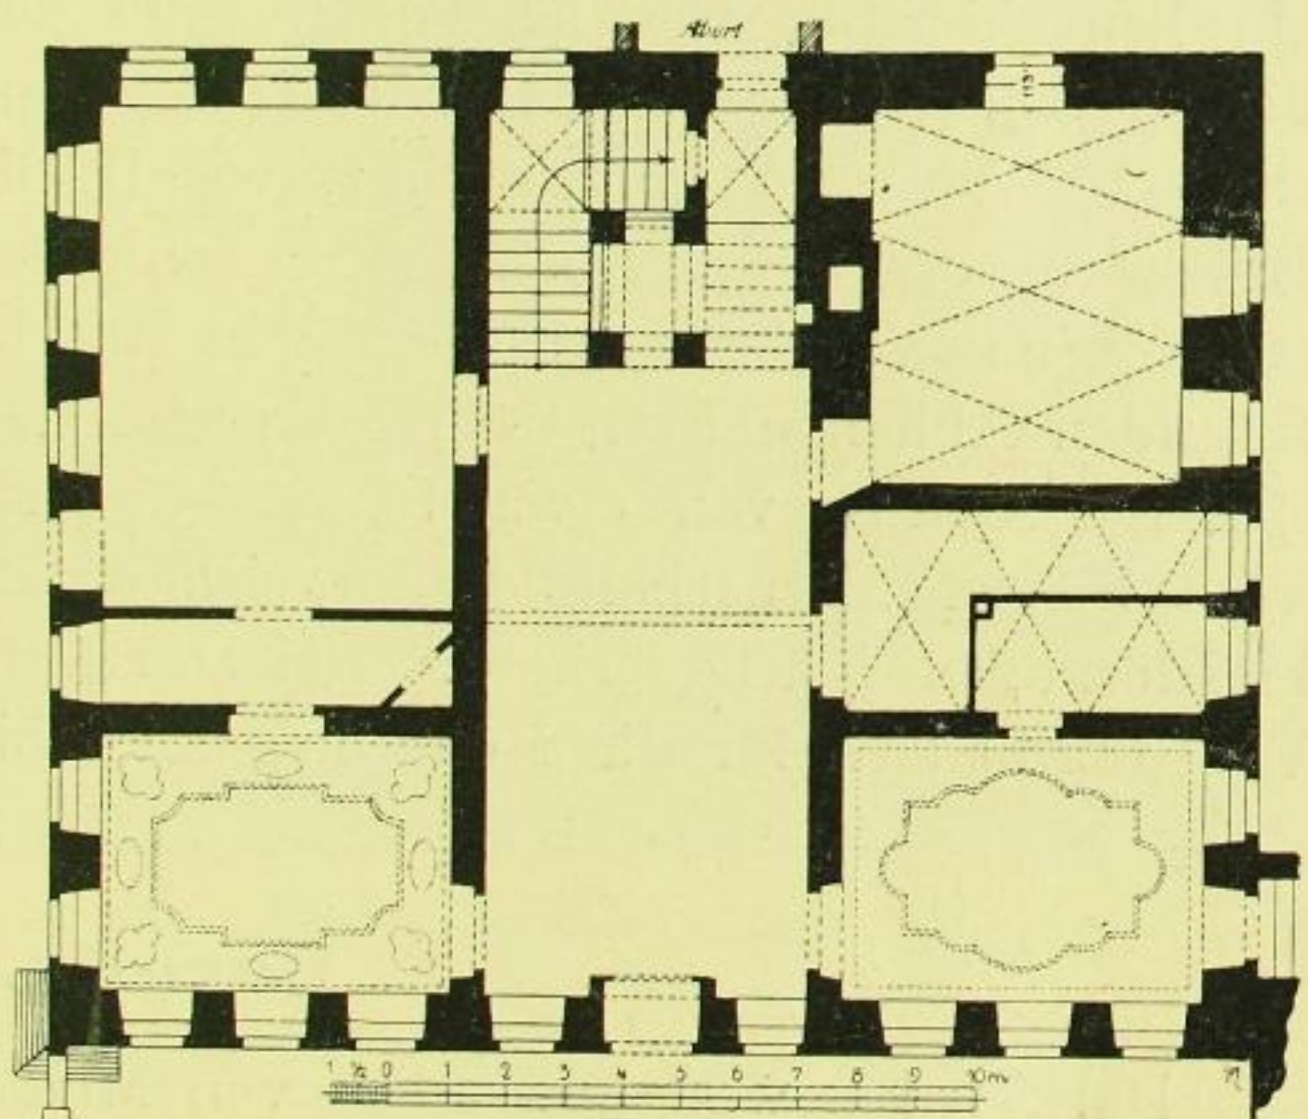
Augustusberg, Grundriß des Erdgeschosses.
